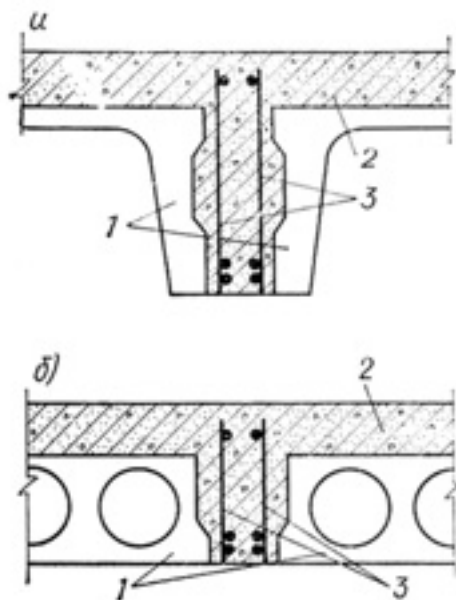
Схема размещения арматурных каркасов между сборными элементами сборно-мономитного перекрытия убежища: а – с применением ребристых плит; б – с применением многопустотных плит; 1 – сборные элементы; 2 – мономитный бетон; 3 – дополнительные арматурные каркасы
